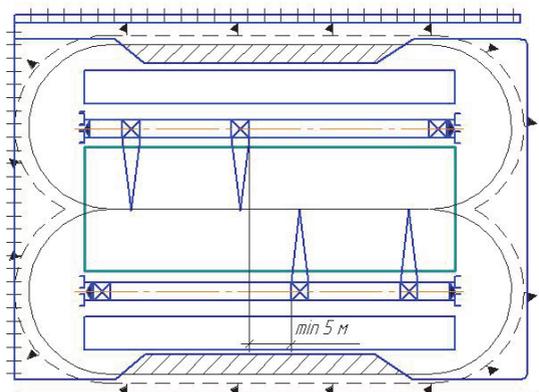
Схема решения стройгенплана при совместной работе двух кранов
